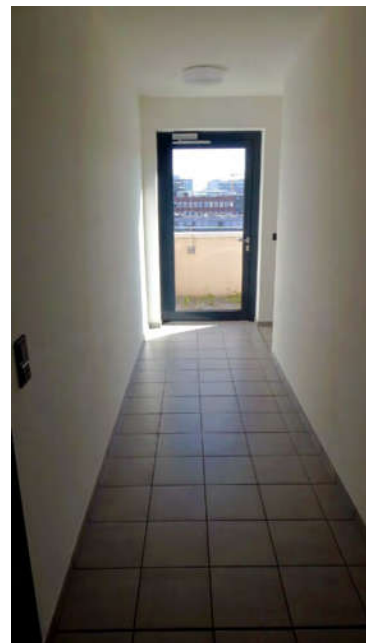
Treppenhaus Zugang Ausblick Straßenseite
